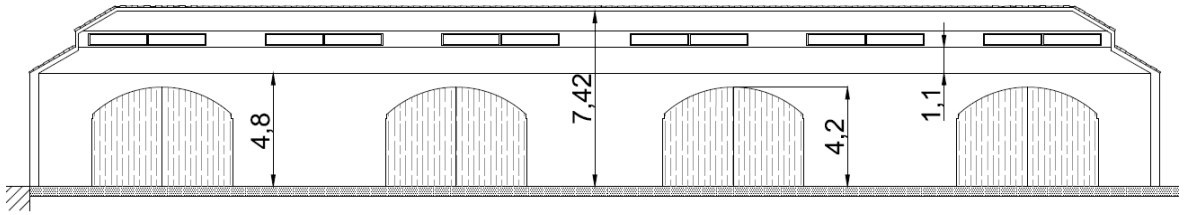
Vista simplificada de la secció A-A' del Plànol 20. Vistes en planta i alçat de la planta superior de la nova edificació.
